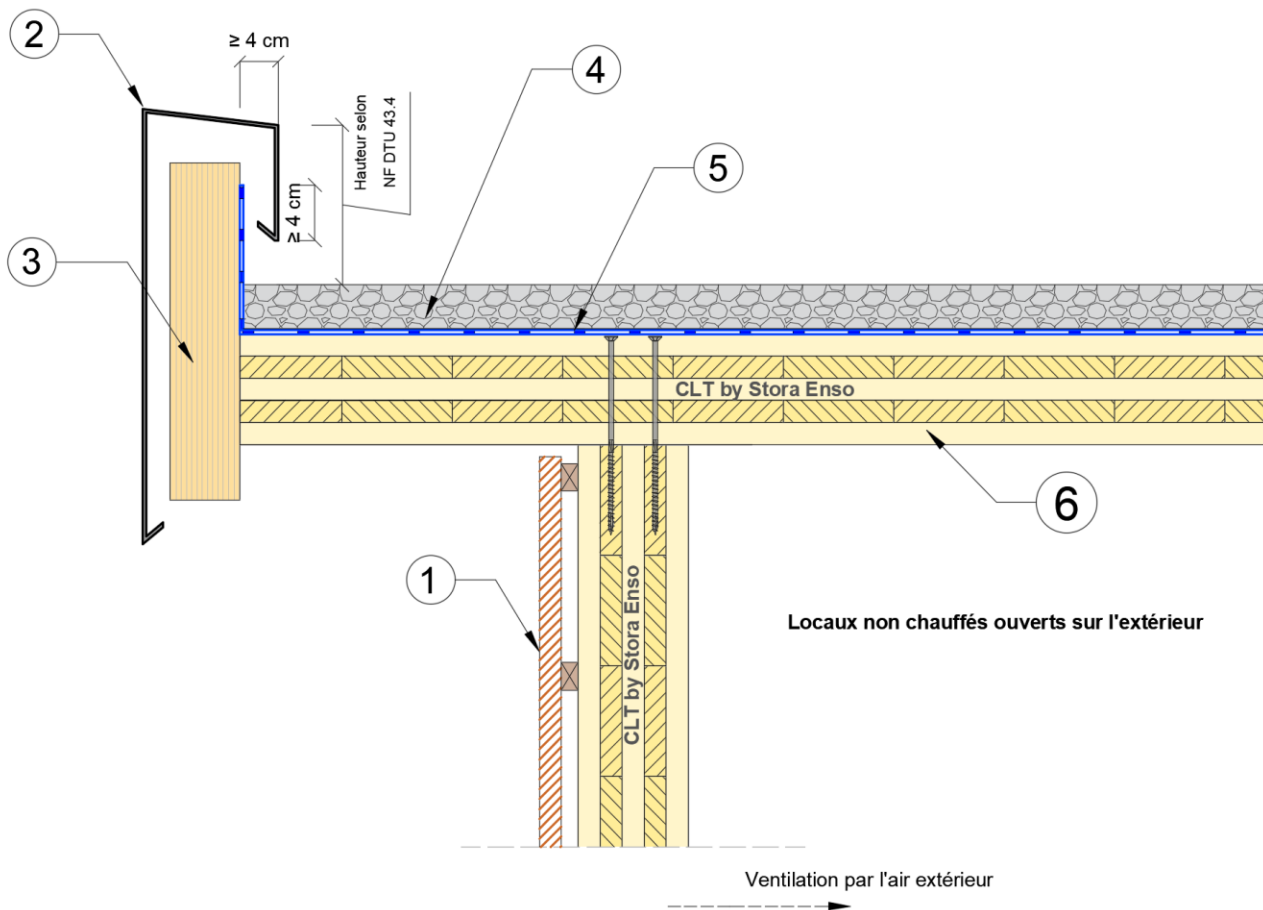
Toiture froide ventilée, non isolée et inaccessible - Acrotère en Stora Enso CLT filant- Coupe perpendiculaire à la pente
